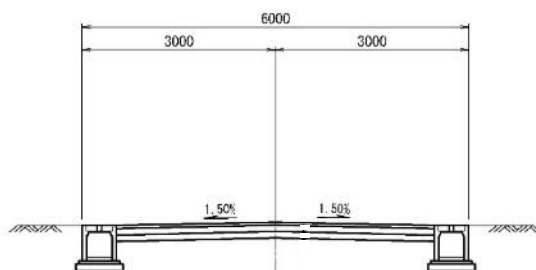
(9) 標準断面図 (特殊道路 幅員 6.0m)
